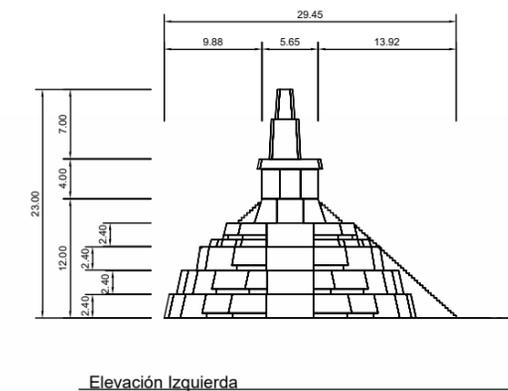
c: Elevación lateral fachada sur del Edificio 1 Realizada: DECA 2018
